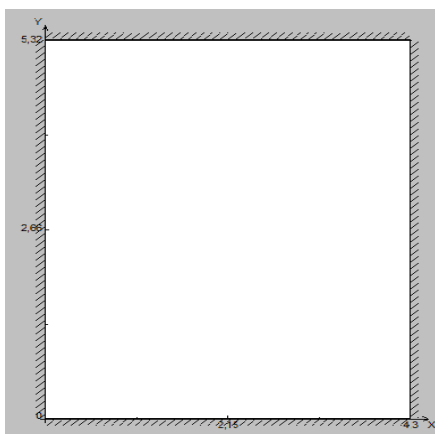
Schéma de la dalle pleine encadrée sur quatre côtés.
